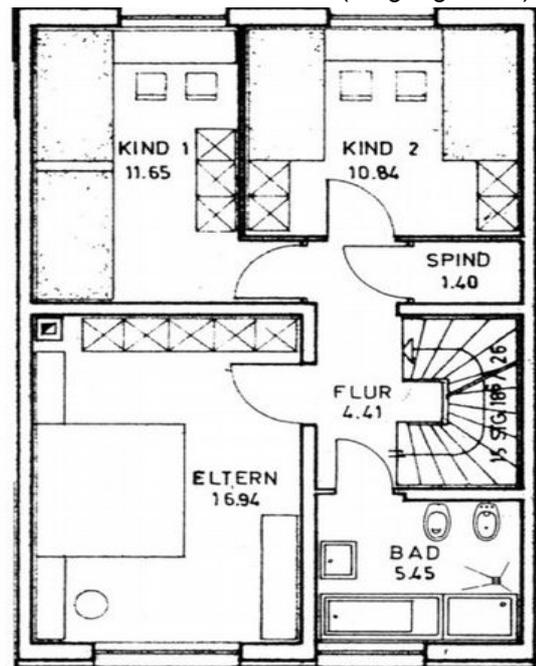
Grundriss der Klinkerhäuser (Eingang unten)
